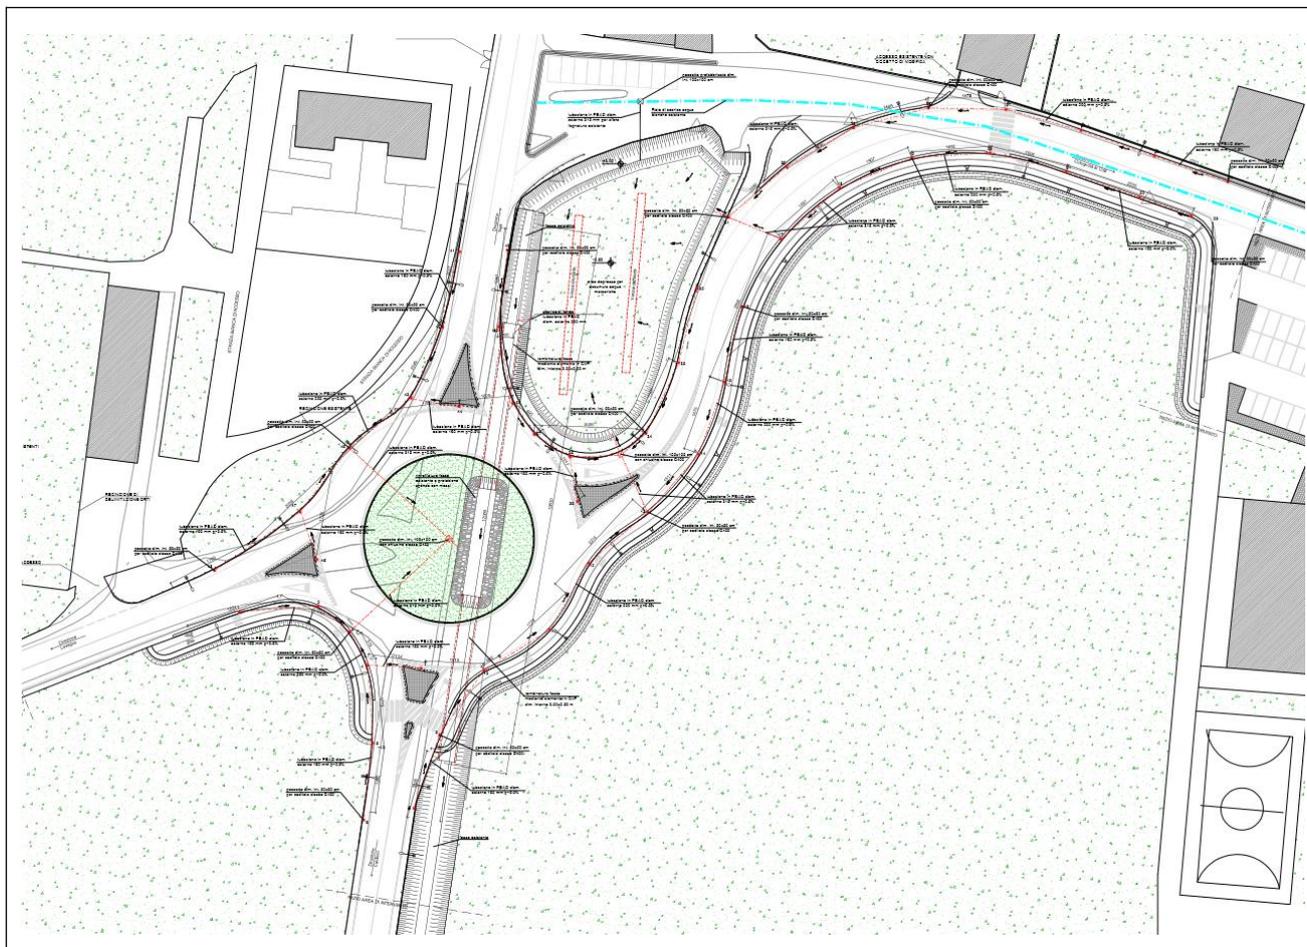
Planimetria rete smaltimento acque meteoriche in progetto
